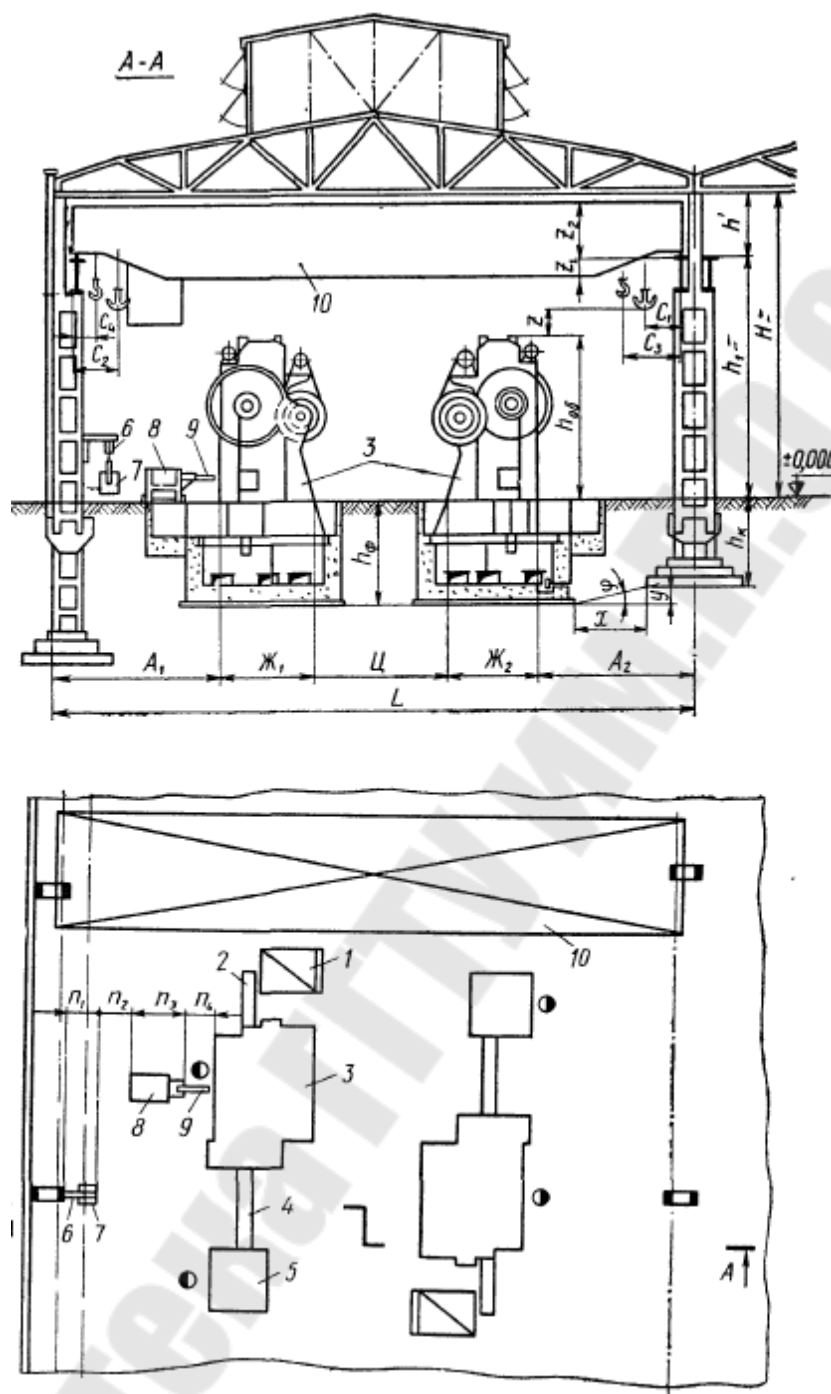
Схема взаимного расположения фундаментов колонн и оборудования:
